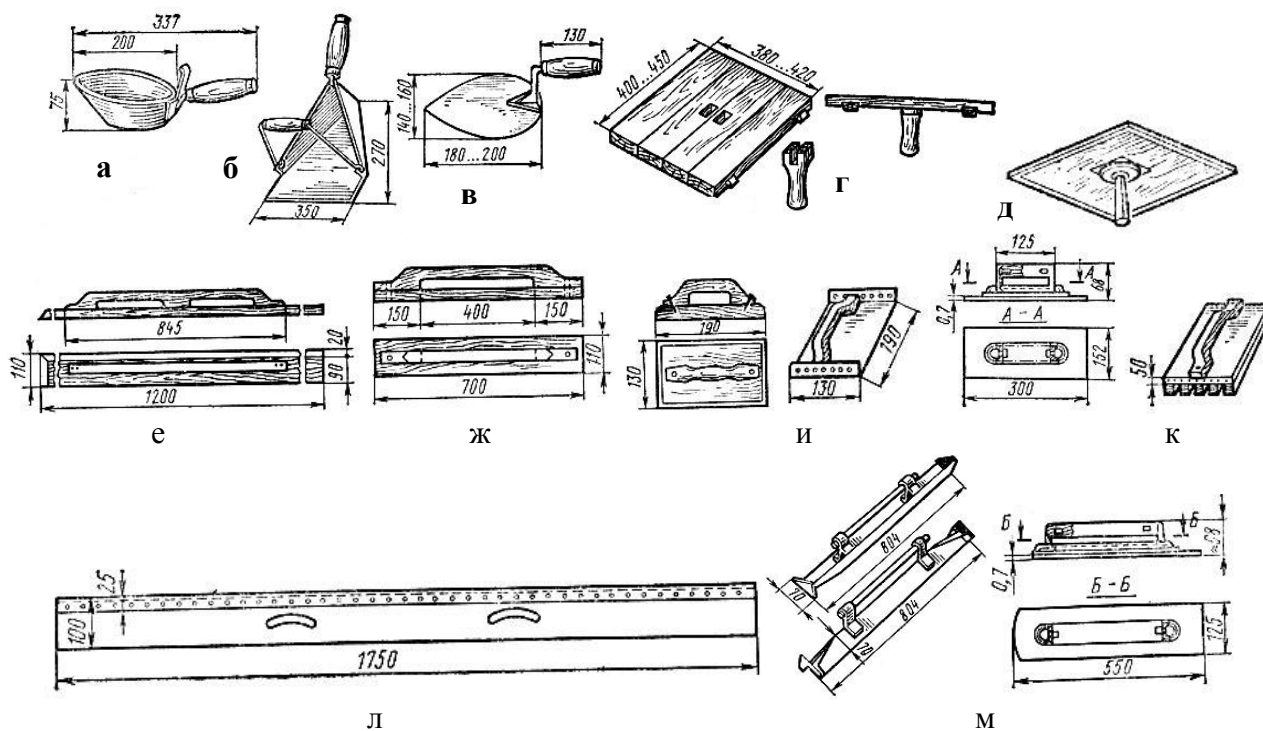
Ручні інструменти для тинькування: а – ківш; б – совок; в – кельма; г, д – соколи; е, ж – напівтерки; и, к – терки; л – правило; м – гладила
